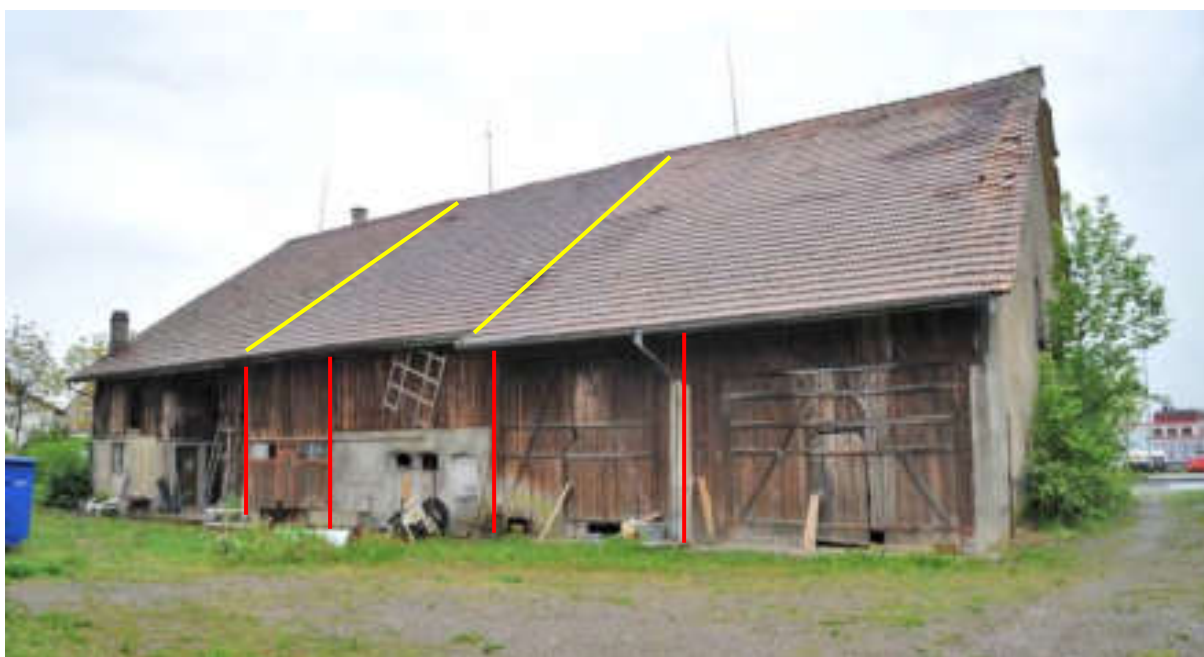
Nördliche Trauffassade mit Nutzungsaufteilung in ein Wohnhaus mit rückseitigem Schopf-/Abtrittanbau sowie eine vierzonige Ökonomie. Die Dachfläche zeigt hingegen eine Dreizonigkeit an.
